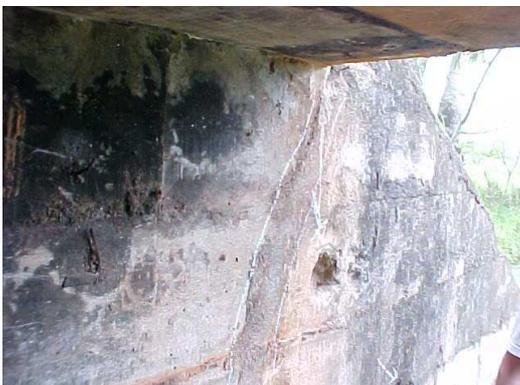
Detalhe da trinca existente na Cortina C2 e pontos de armadura exposta e concreto deslocado na face inferior da ala do lado esquerdo
